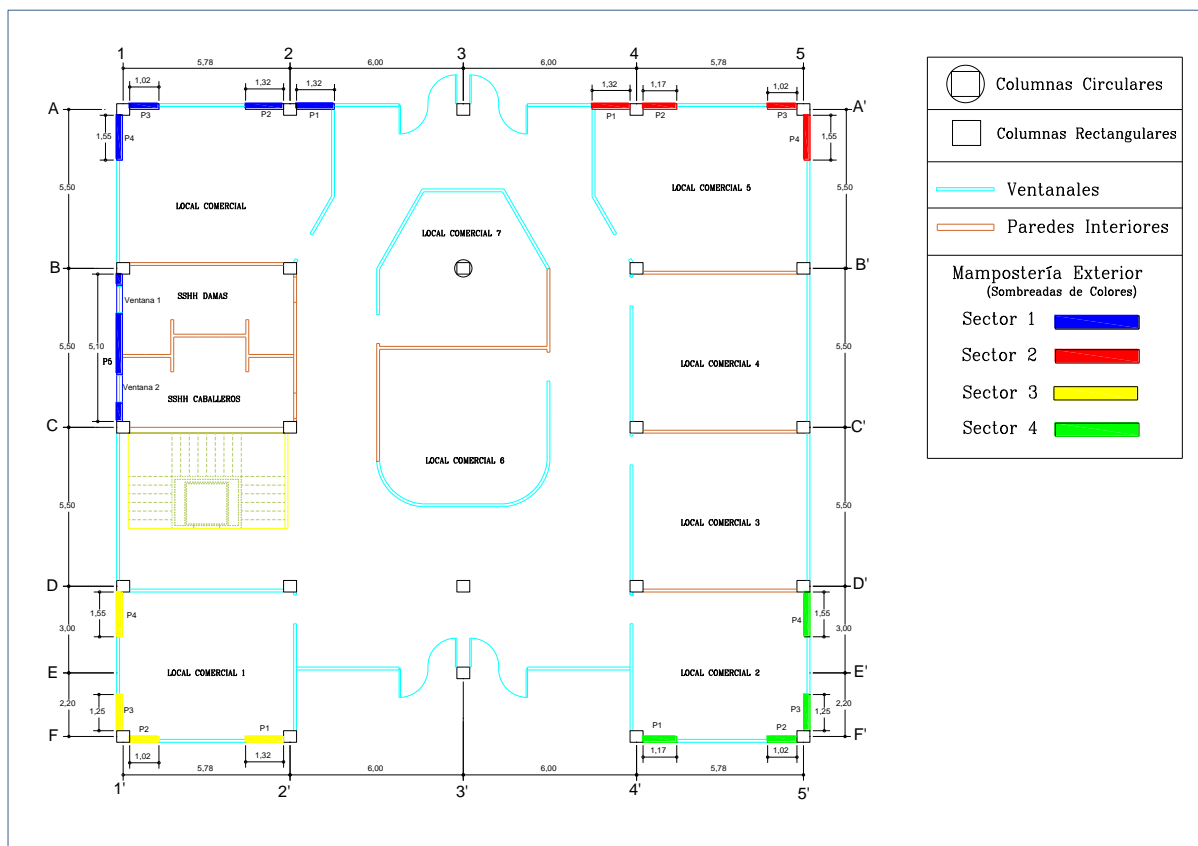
Sectorización de Mampostería Exterior de Bloque P14
